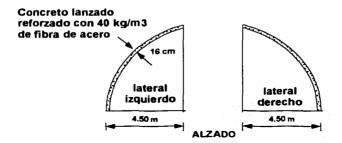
Colocación de concreto lanzado reforzado con fibras de acero, hasta alcanzar un espesor de 16 cm
